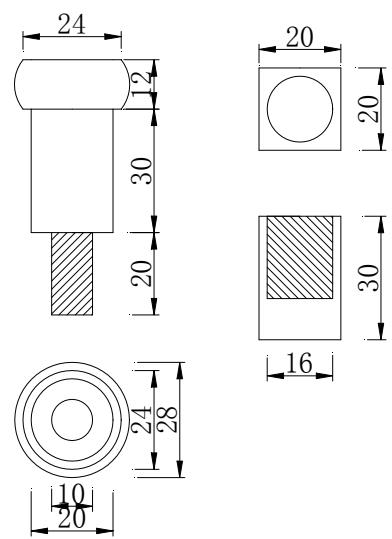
钢结构沉降点标志示意图 (mm)
